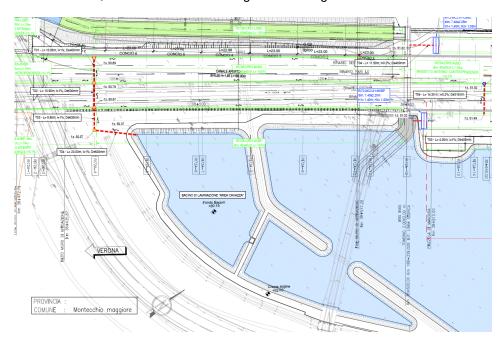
Stralcio planimetrico dello scarico nel bacino di laminazione "Area Cavazza"
